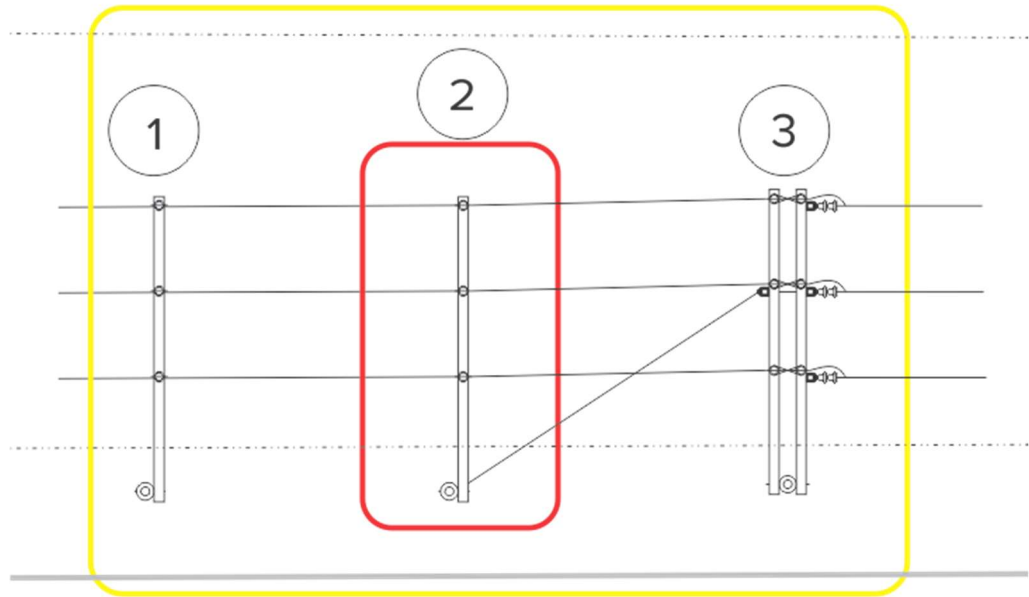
Indicação de estrutura de trabalho (retângulo vermelho) e estruturas adjacentes (retângulo amarelo).
